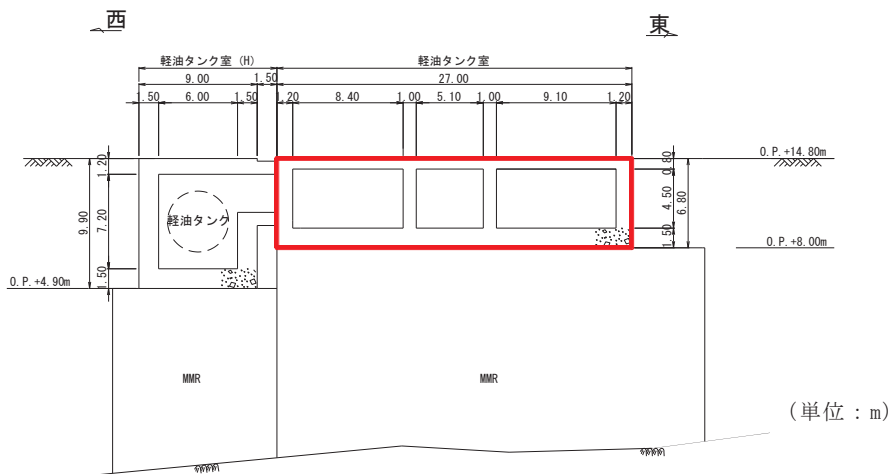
軽油タンク室断面図 (C-C 断面, 東西 (ポンプ室))
